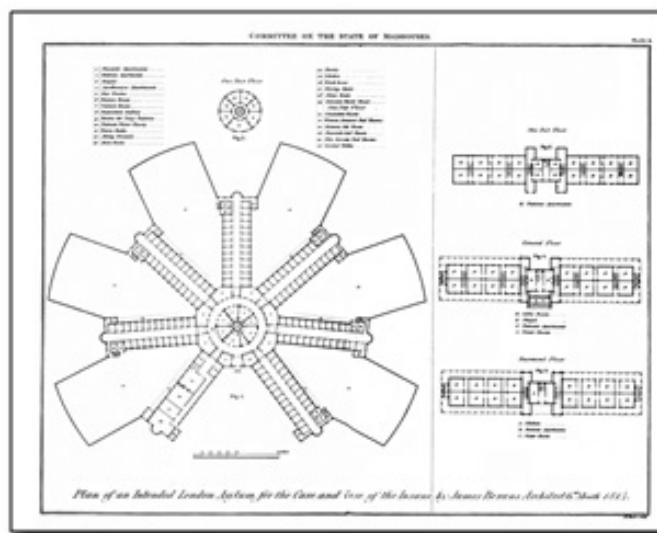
Plano para el Asilo de Dementes de Londres, Bevans 1814<sup>18</sup>
